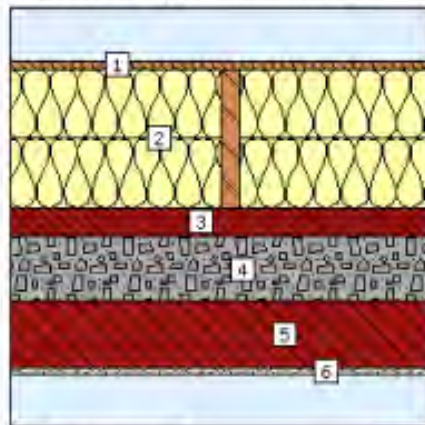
Bauteilprofil Variante 1 Strohballe, lasttragend / Holzfußboden – Sarleinsbach 2011
